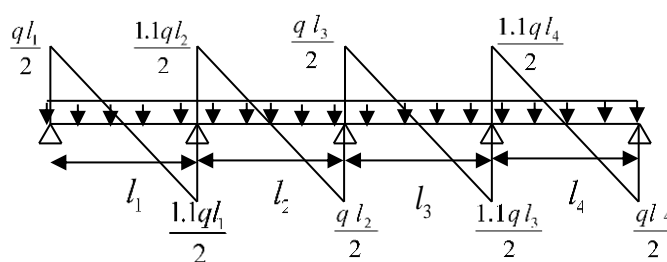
Effort tranchant d'une poutre à plus de 2 travées
